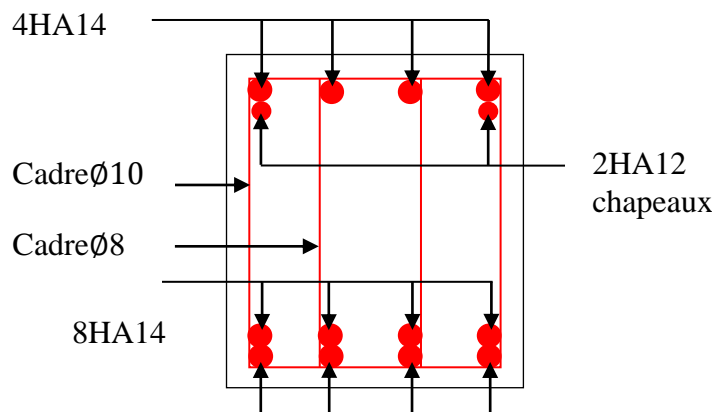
Schéma de ferraillage de la poutre brisée.
